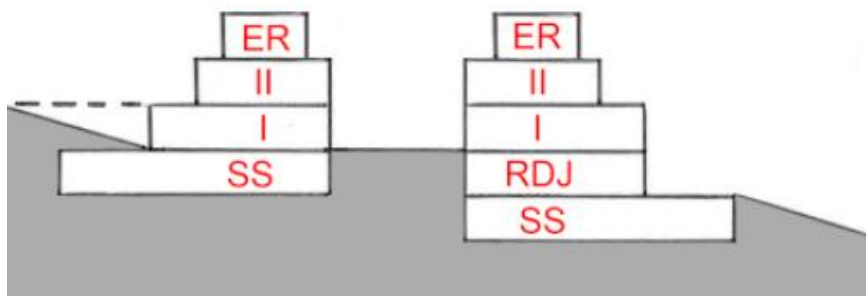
Constructions sur terrain en forte pente avec un rez-de-jardin.
